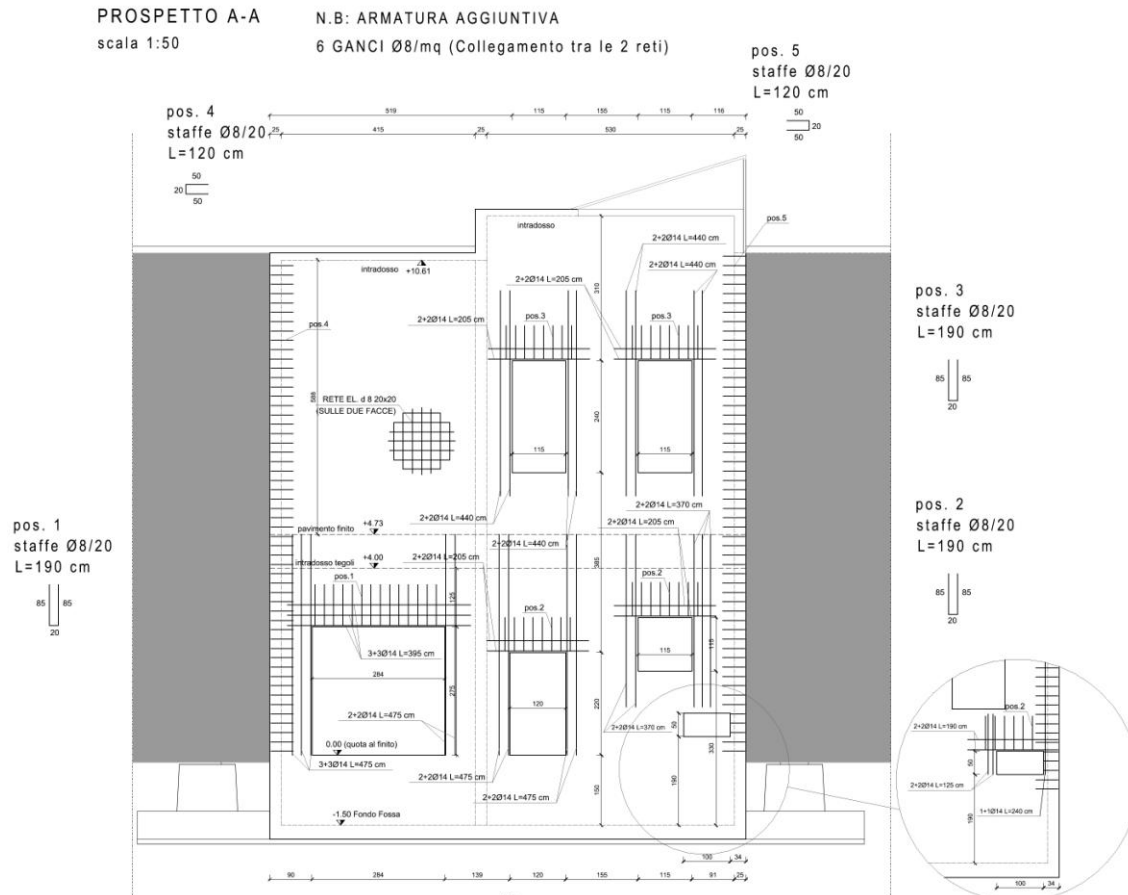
Particolare di A.2003.cap.us.T11 - Armature pareti nucleo 3 - Prospetto parete
